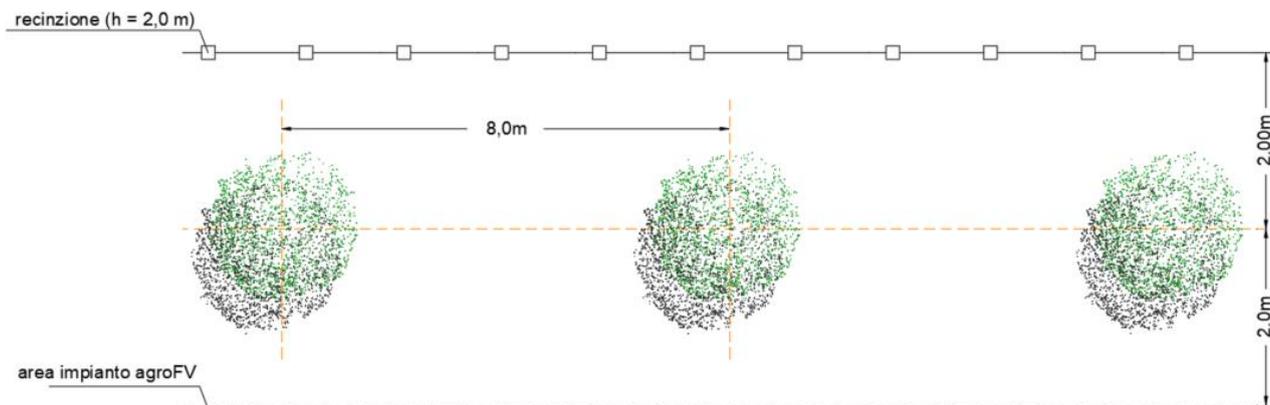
Stralcio di sezione dell'area dell'impianto.
